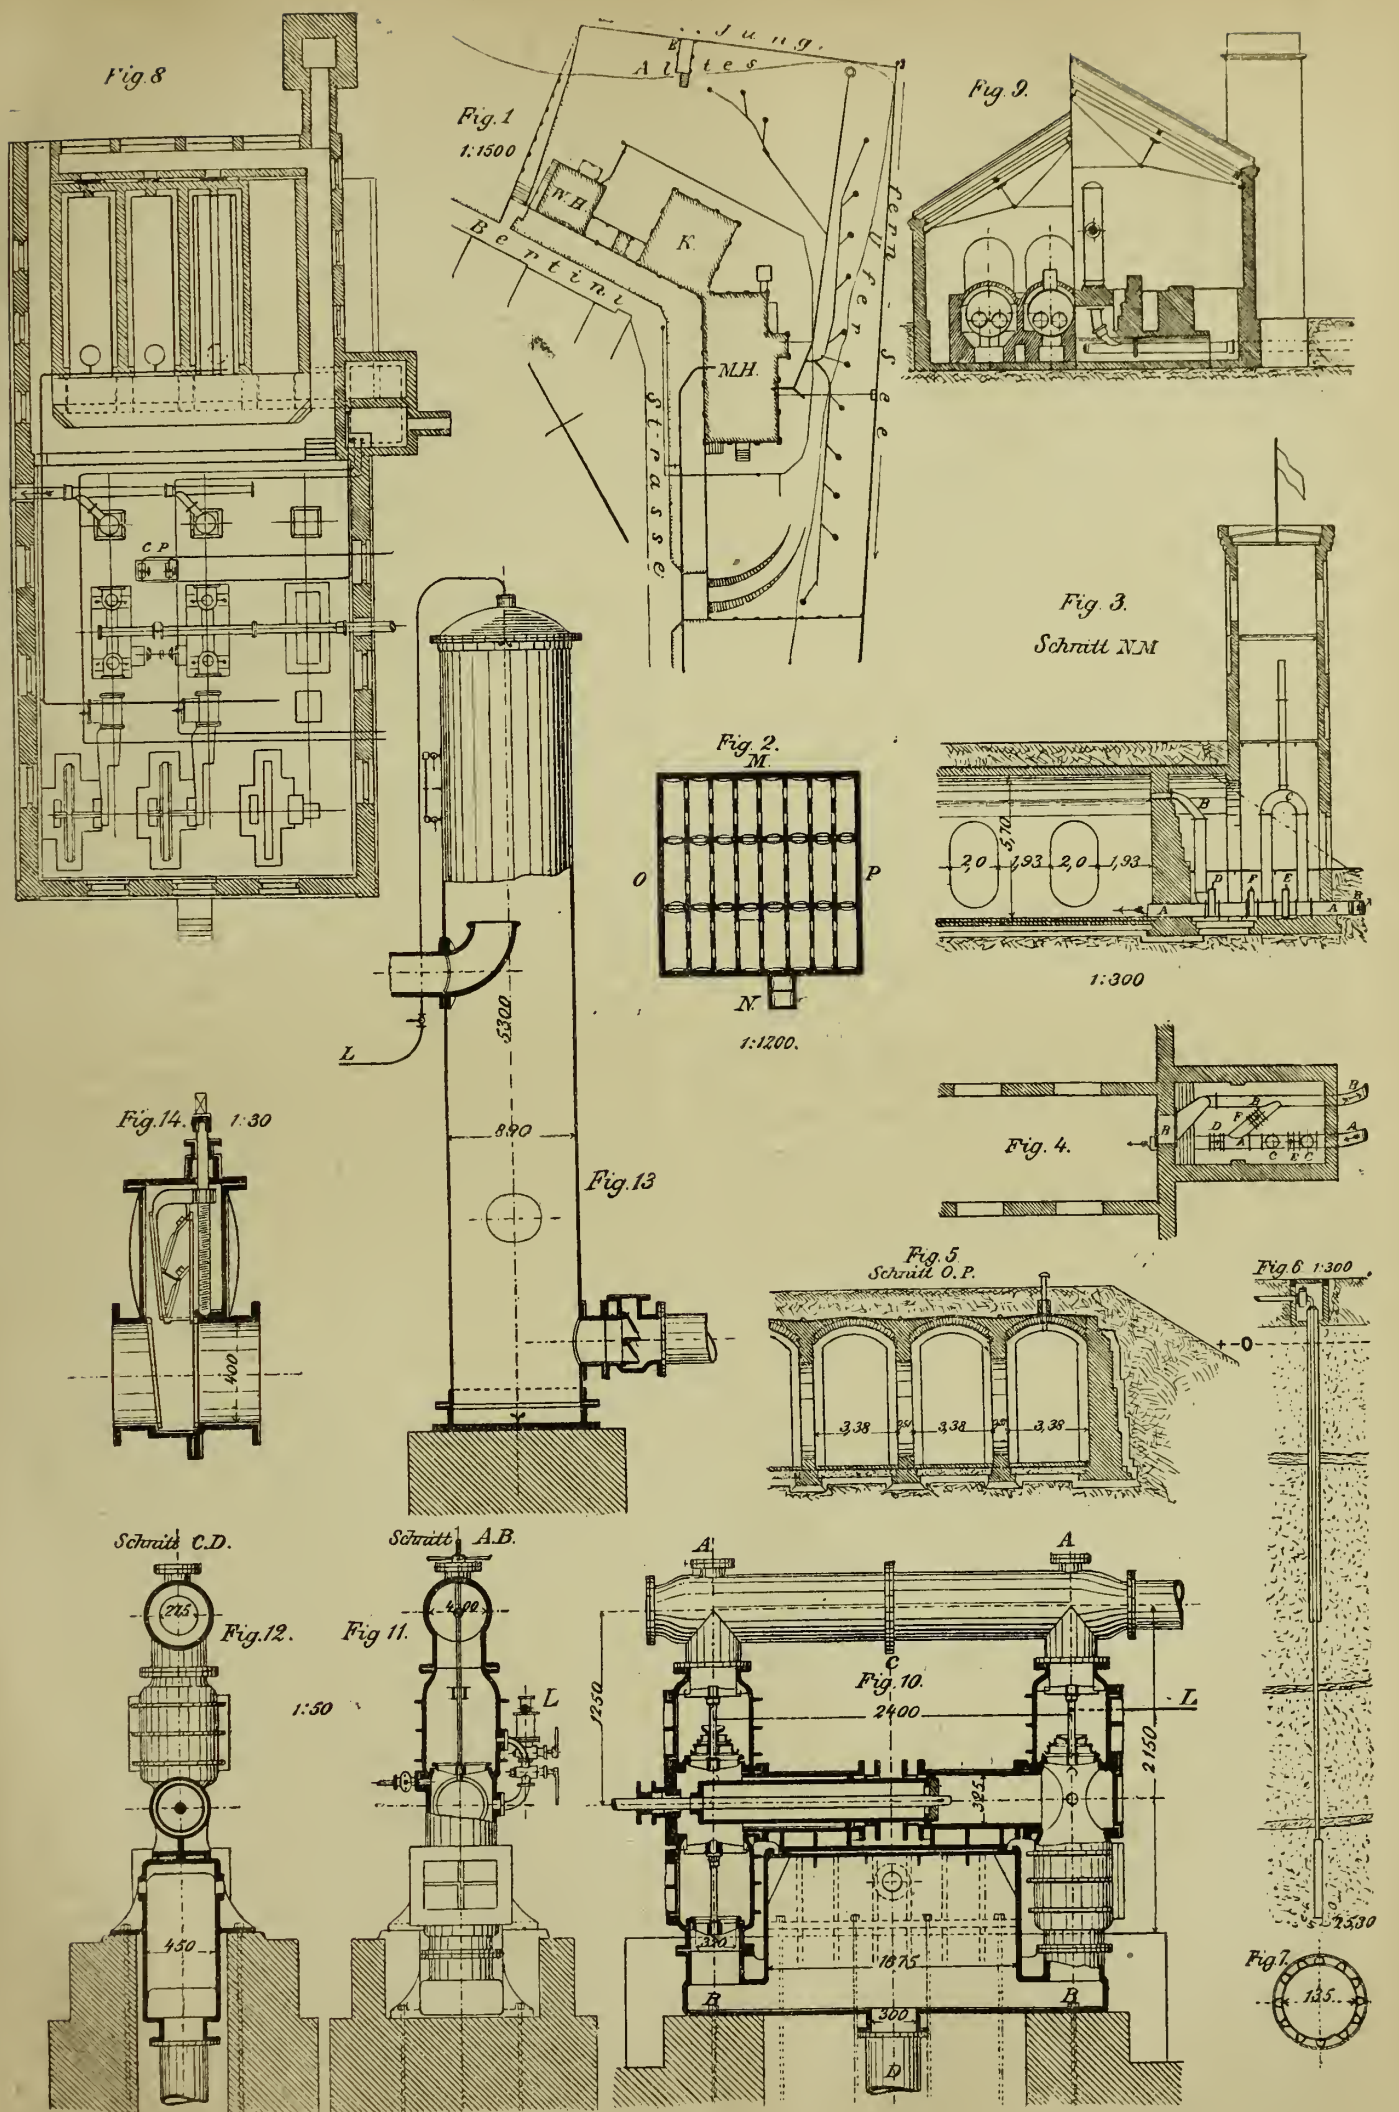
Situat.-Pl. d. Pump-Station. Fig. 4. Ventil-kammer. (Grundriss.) Fig. 8. Masch.-u. Kesselhaus. (Grundriss.) Fig. 10. Pumpen. (Längenschnitt.) Fig. 14. Rückschluss-Ventil zum Reservoir.
